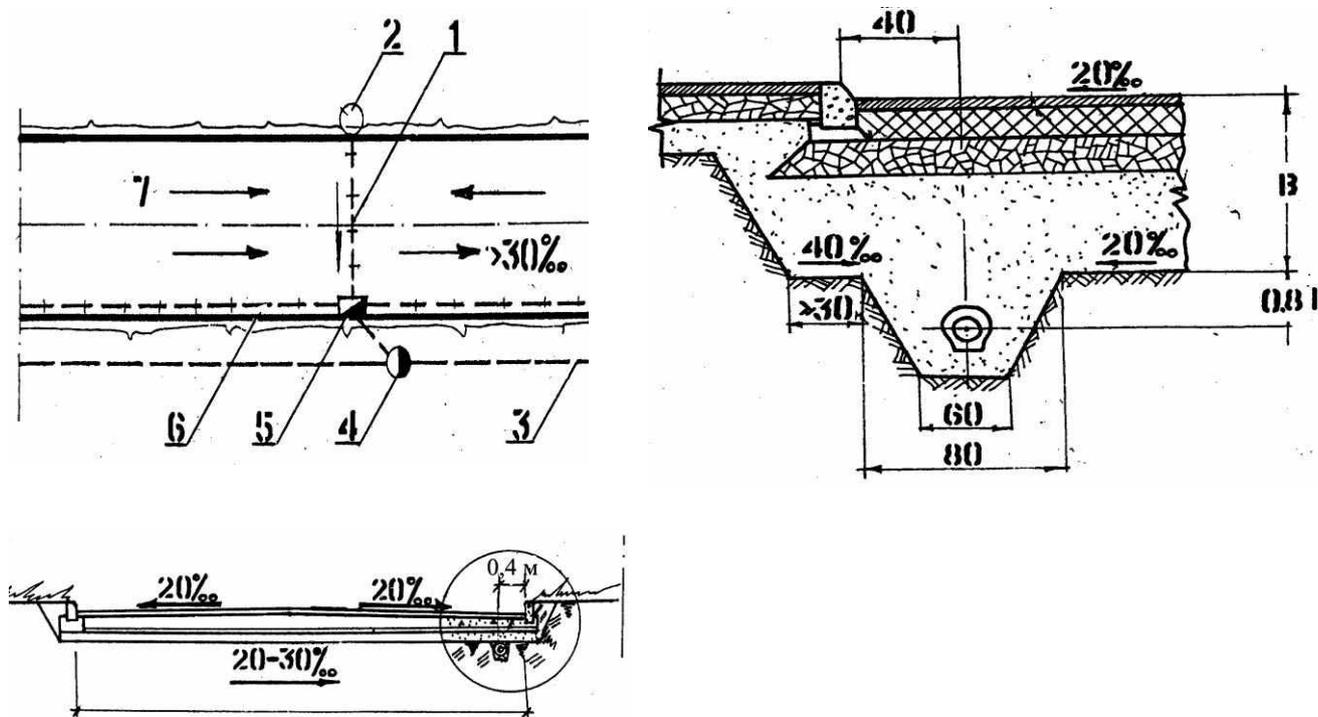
Схема размещения и конструкции сопутствующего дорожного дренажа
